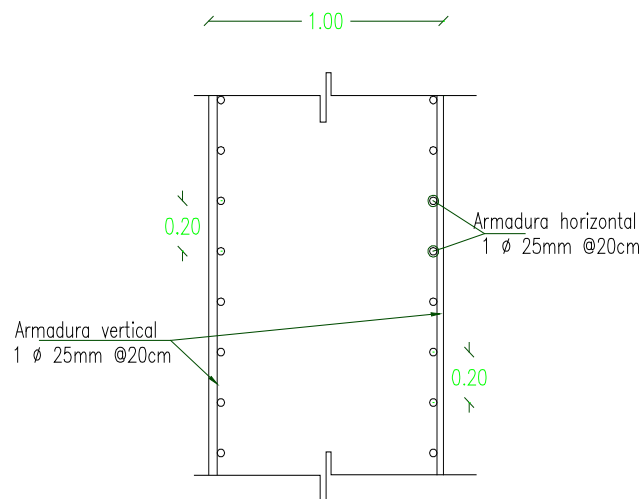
Corte típico de muro (Pantalla y contrafuertes)
